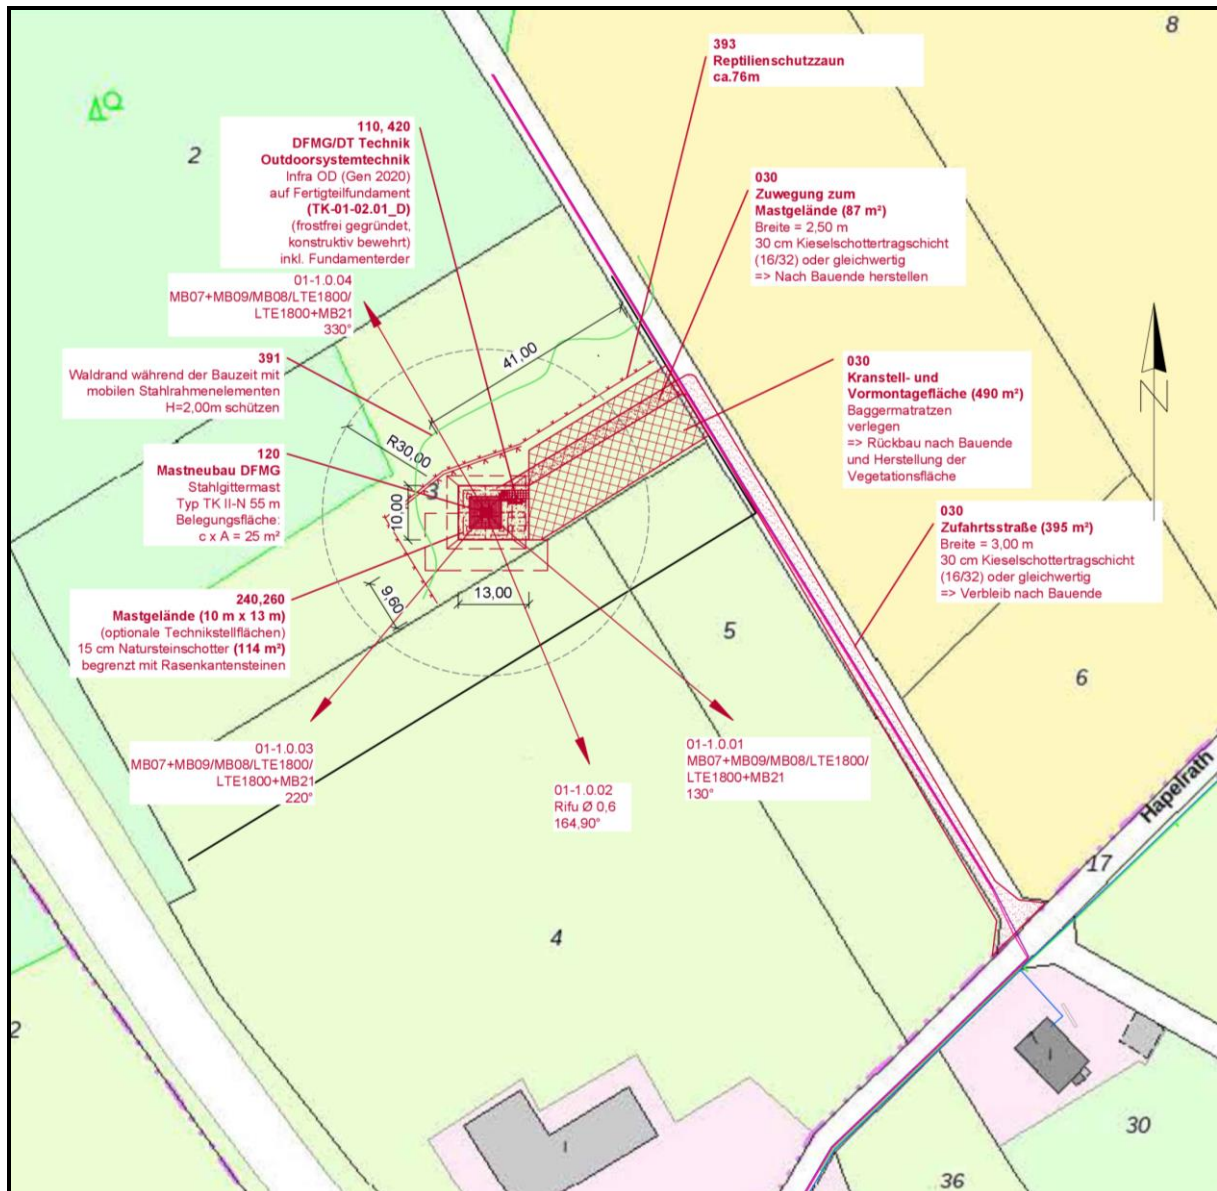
Lageplan (ohne Maßstab, ©TKS GmbH)
